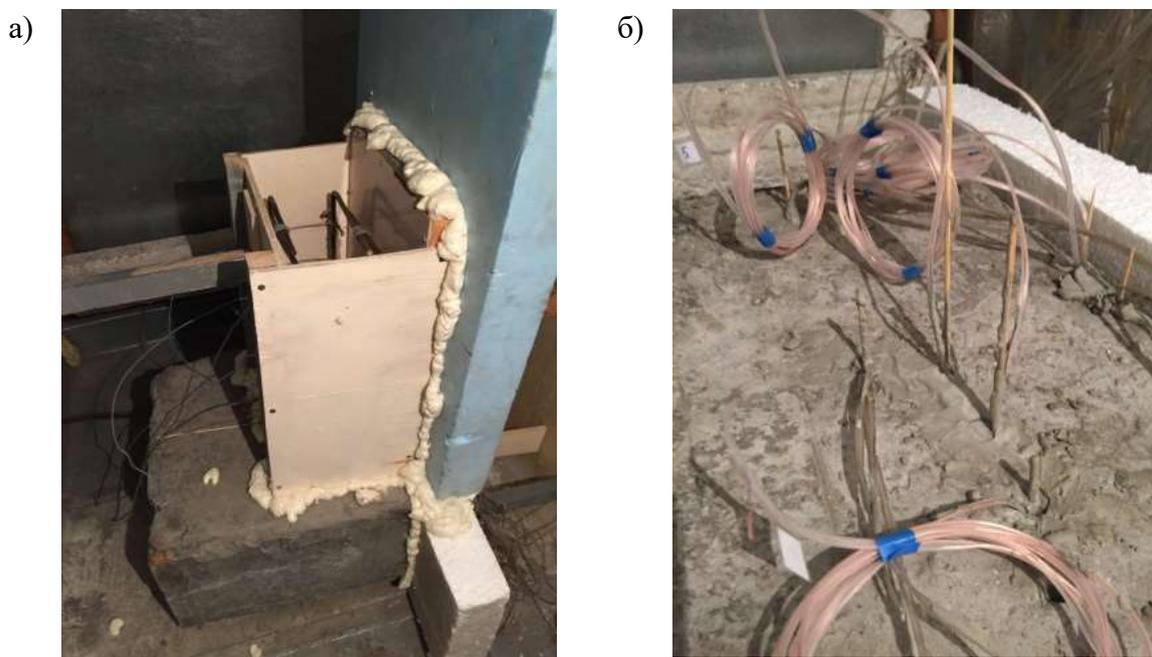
Модель фрагмента колонны, бетонируемой на мёрзлом перекрытии:
